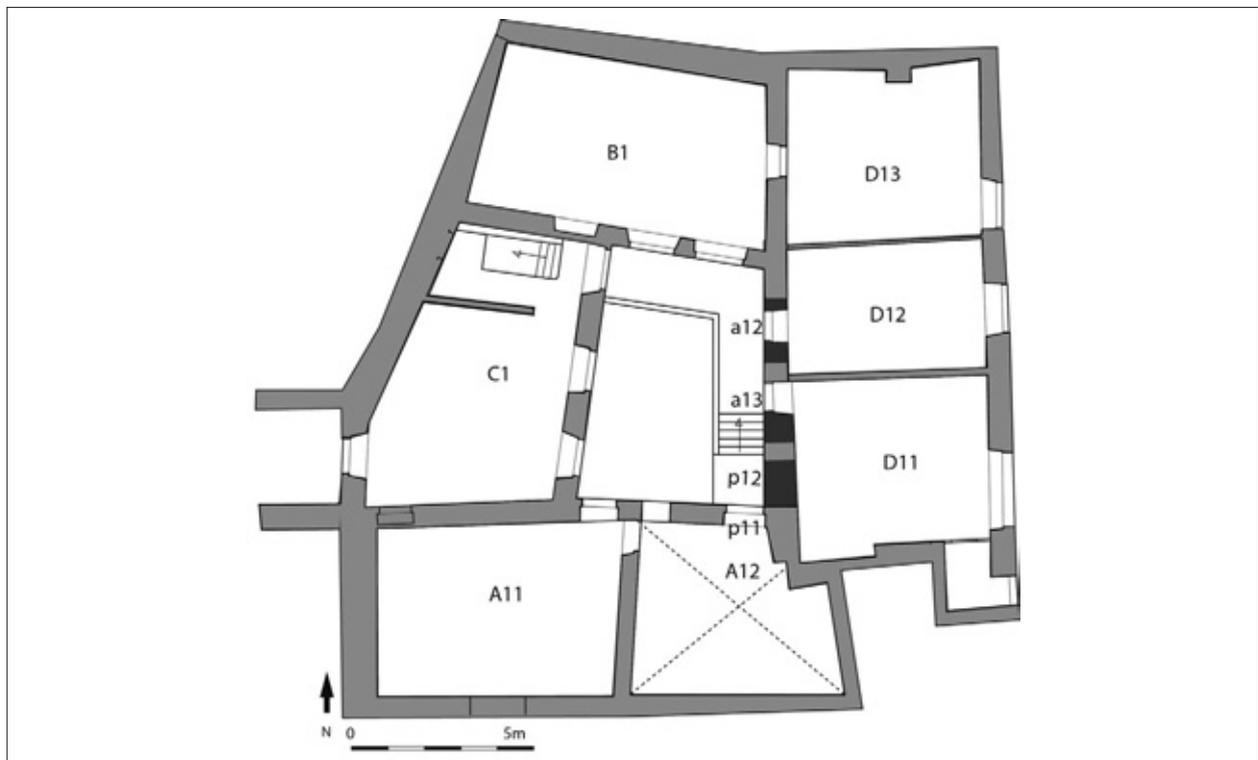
PLAN DU PREMIER ÉTAGE (a : arcade ; p : porte). Relevé et dessin Françoise Galés, Baptiste Quost.
